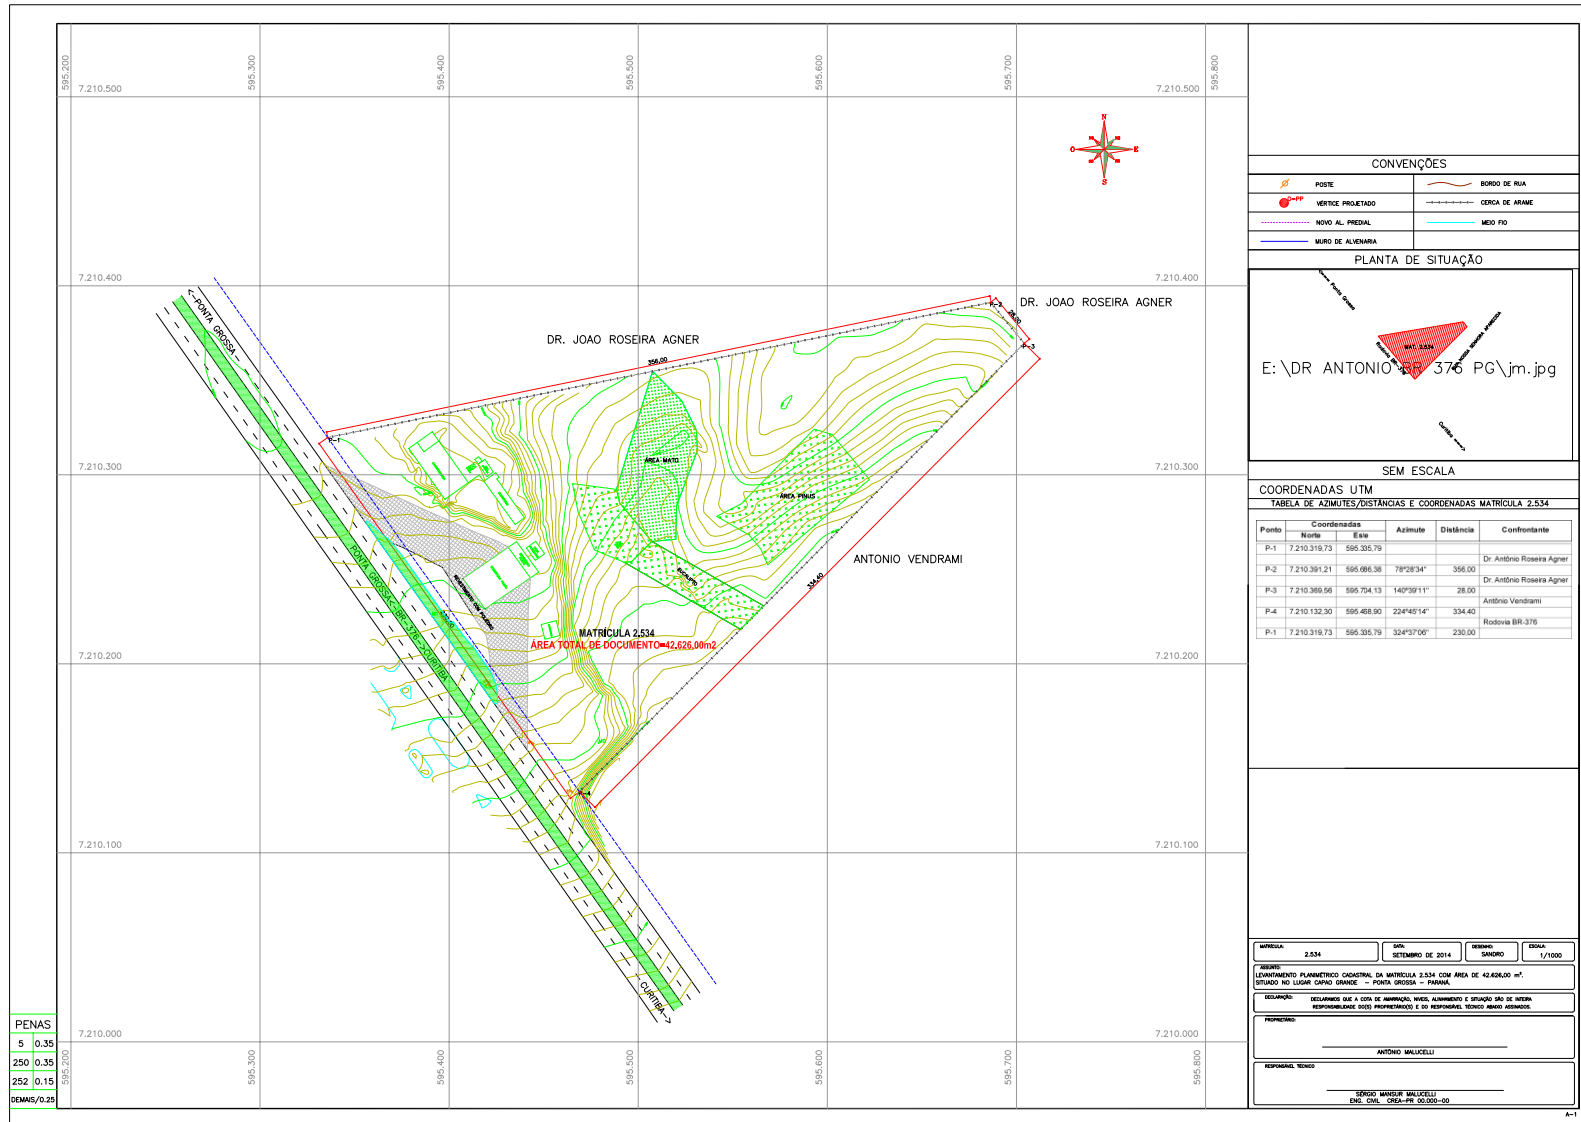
Levantamento planialtimétrico do local do empreendimento.
